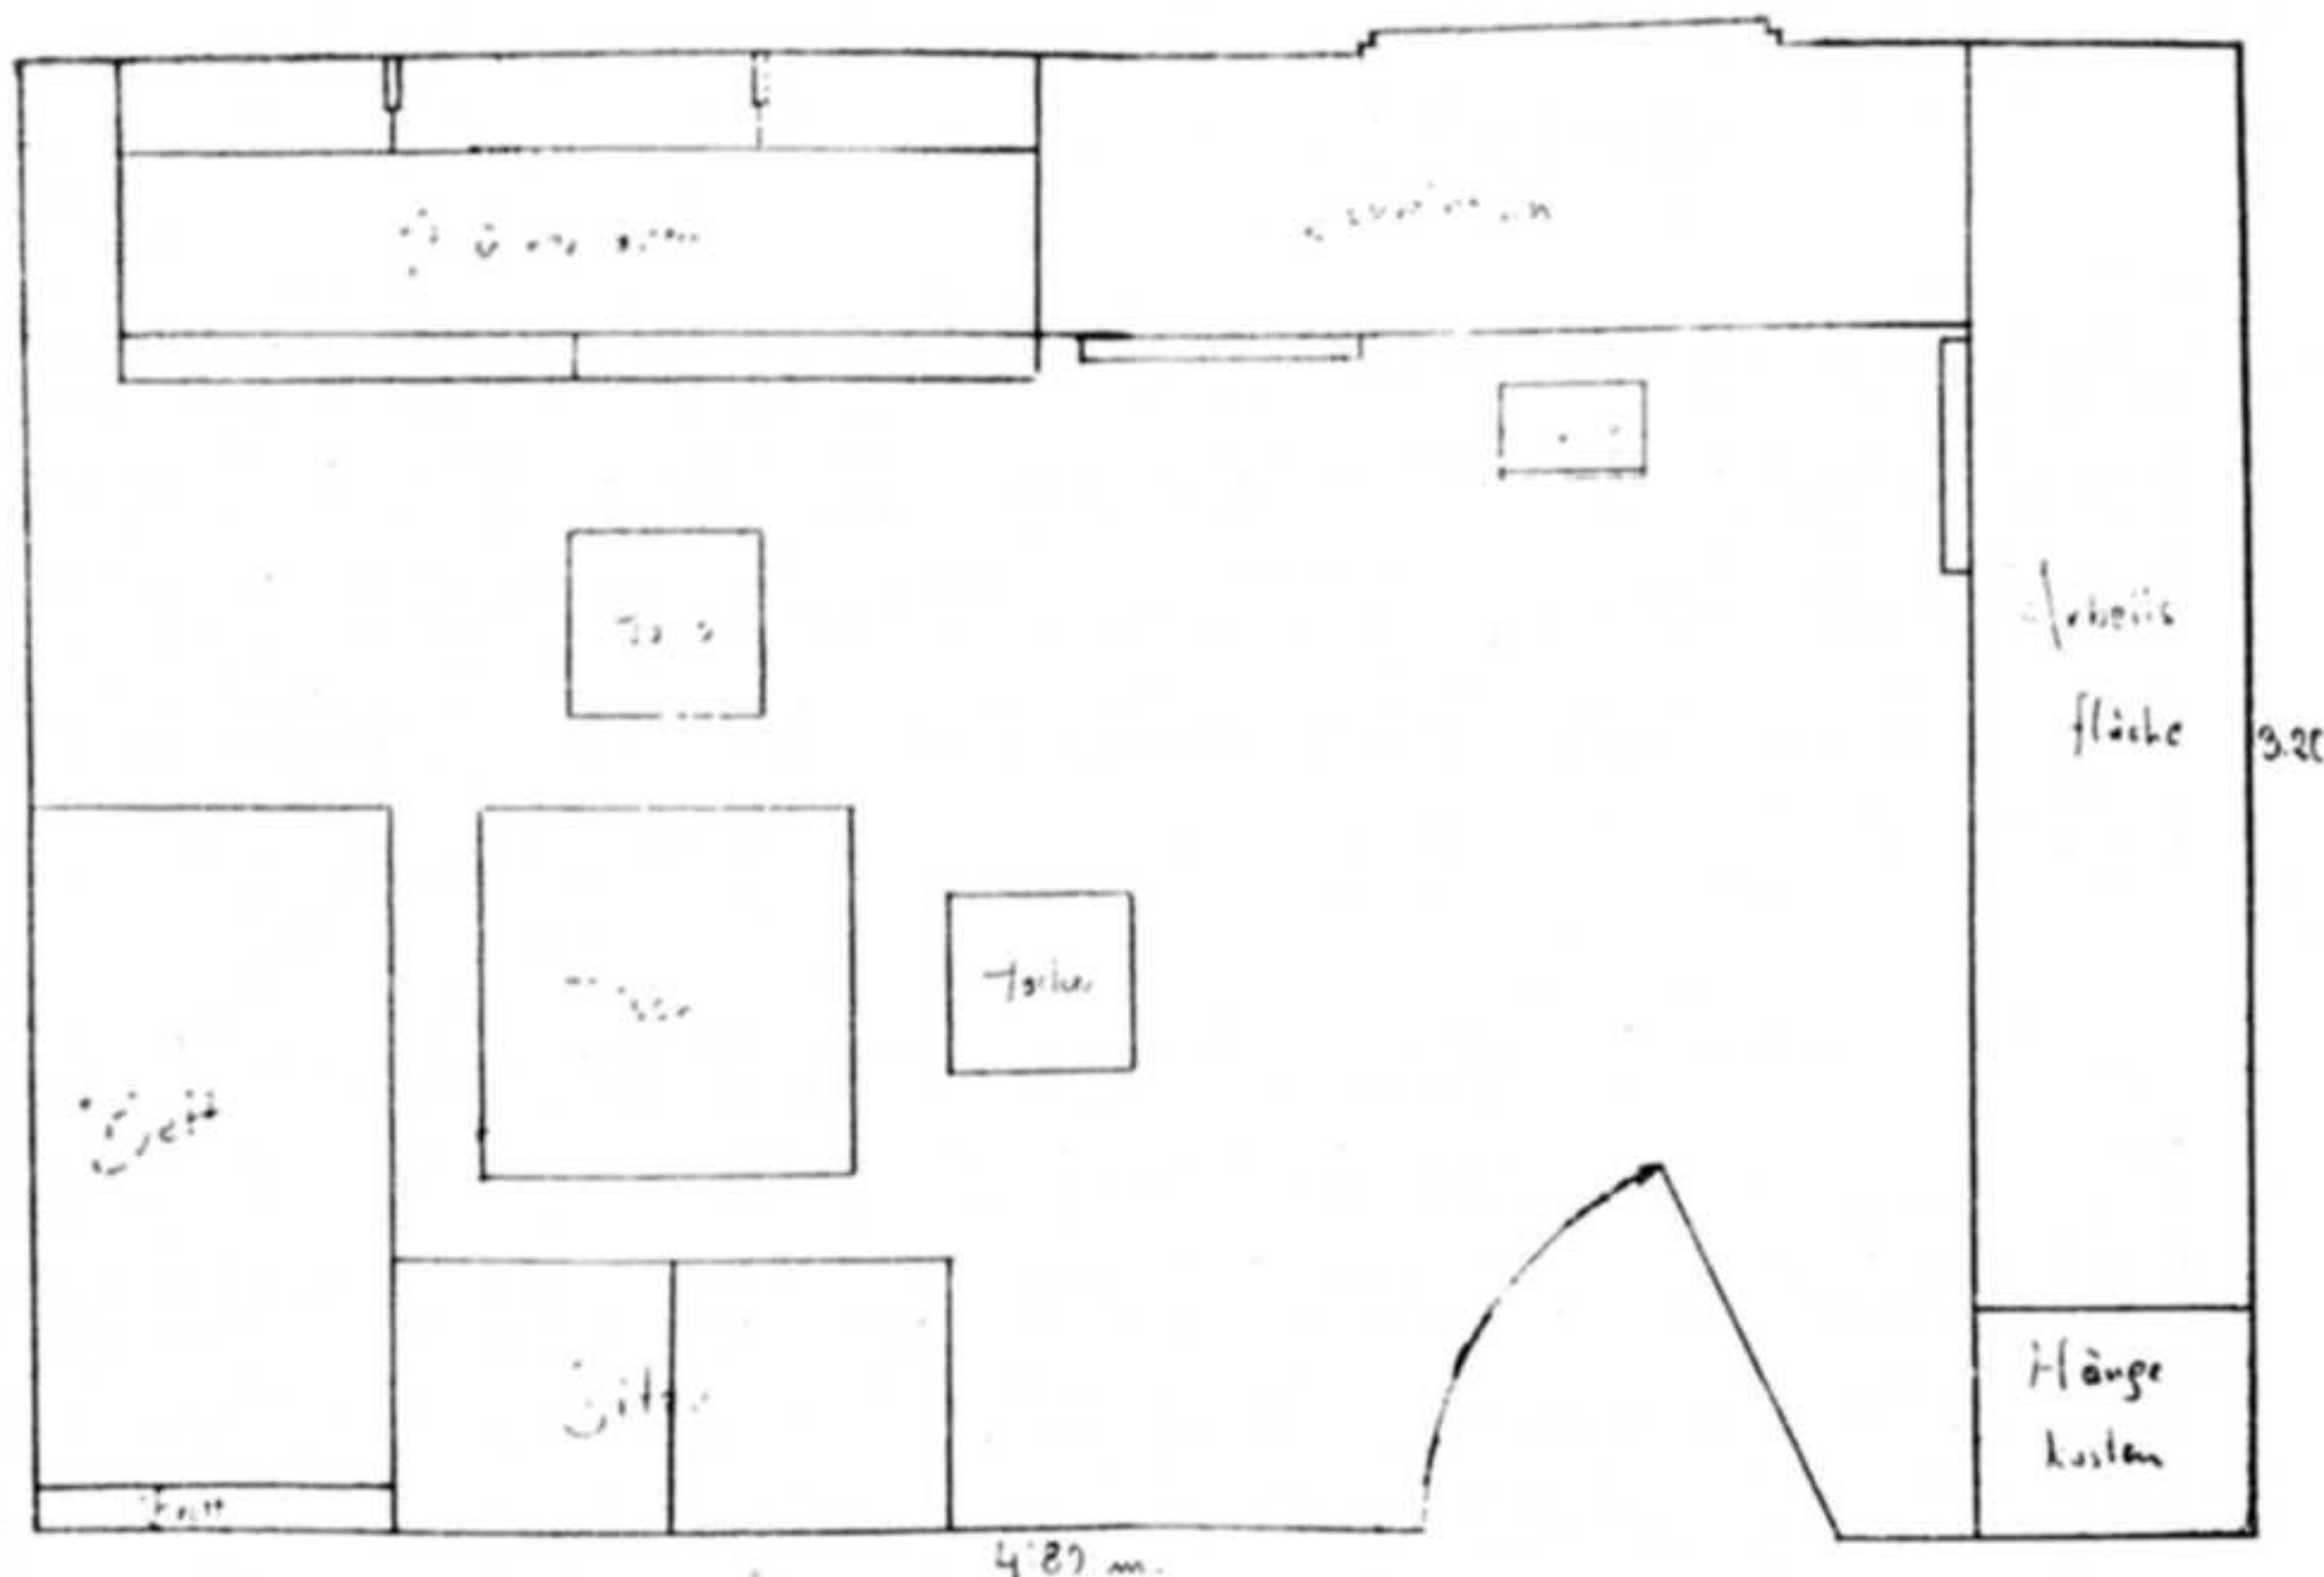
Grundrißversuch zu einem „Wunschzimmer“ (Originalplan 1 : 20), Unterricht Prof. Hauke
